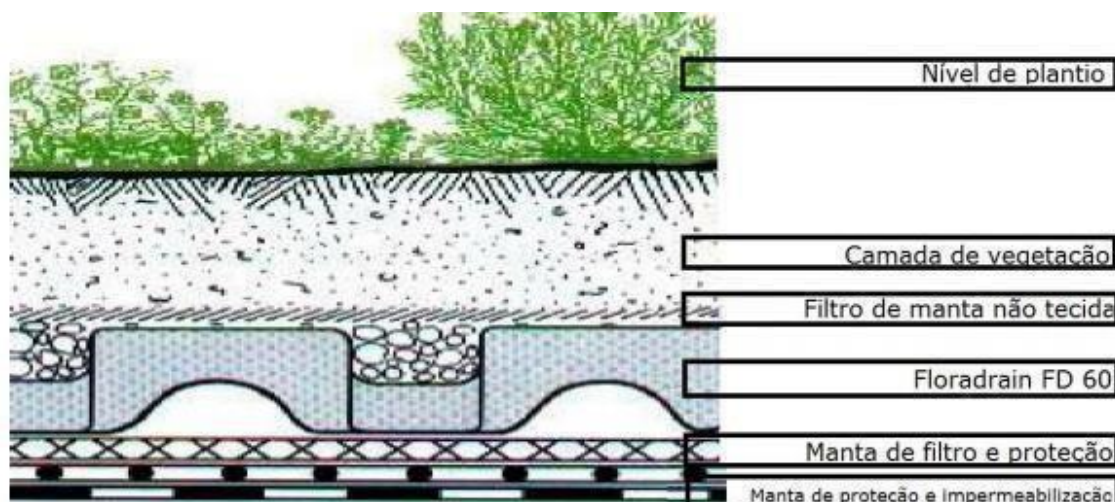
Corte esquemático de telhado verde extensivo. Fonte: Araújo (2007).
